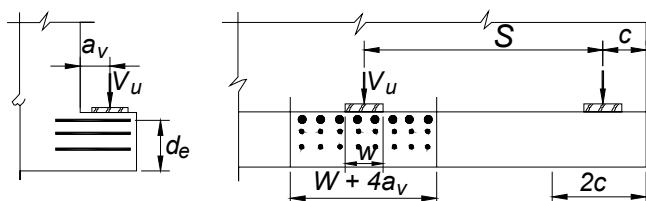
Diseño al corte de los resaltos horizontales
